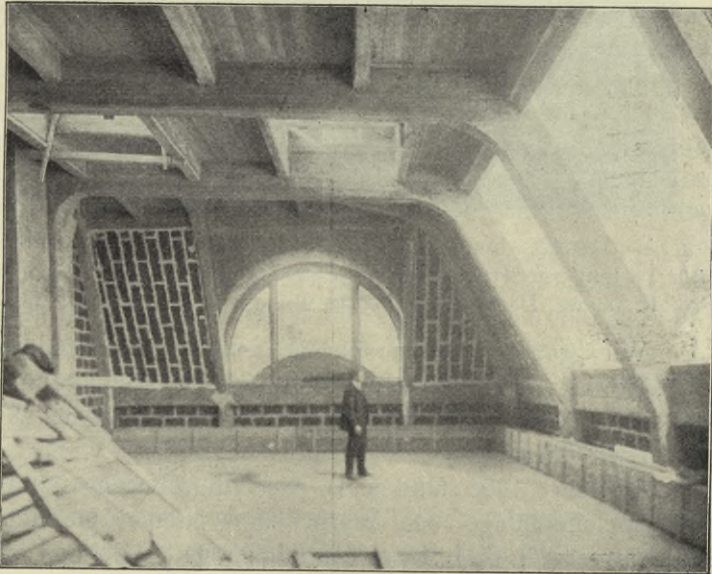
Dachräume im Geschäftshause Hofmeier in Wien
